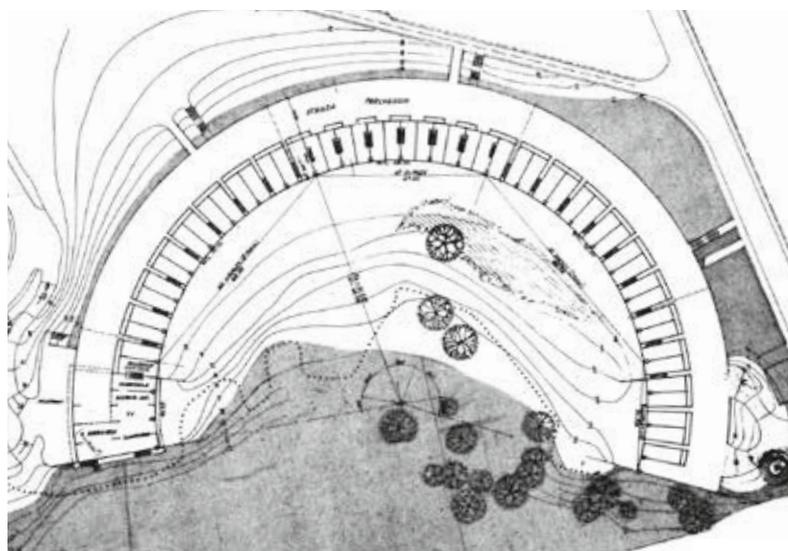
Wohnhaus Talponia, Grundriss Gesamtgebäude
